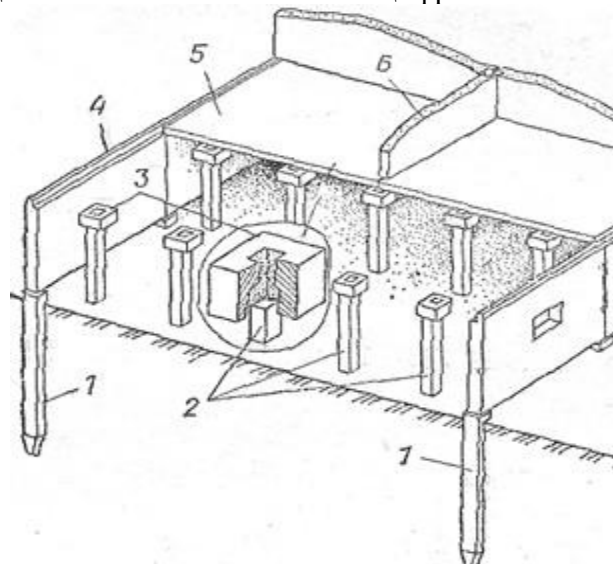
Конструктивные элементы здания на безростверковом свайном фундаменте
